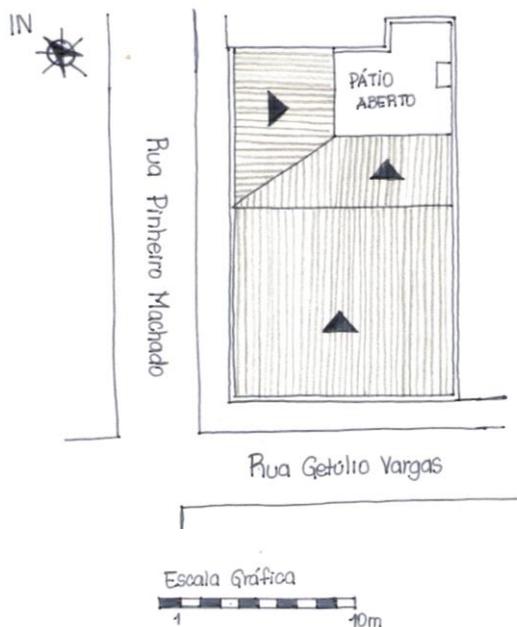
Localização da edificação da esquina da Avenida Getúlio Vargas com a Rua Pinheiro Machado.
